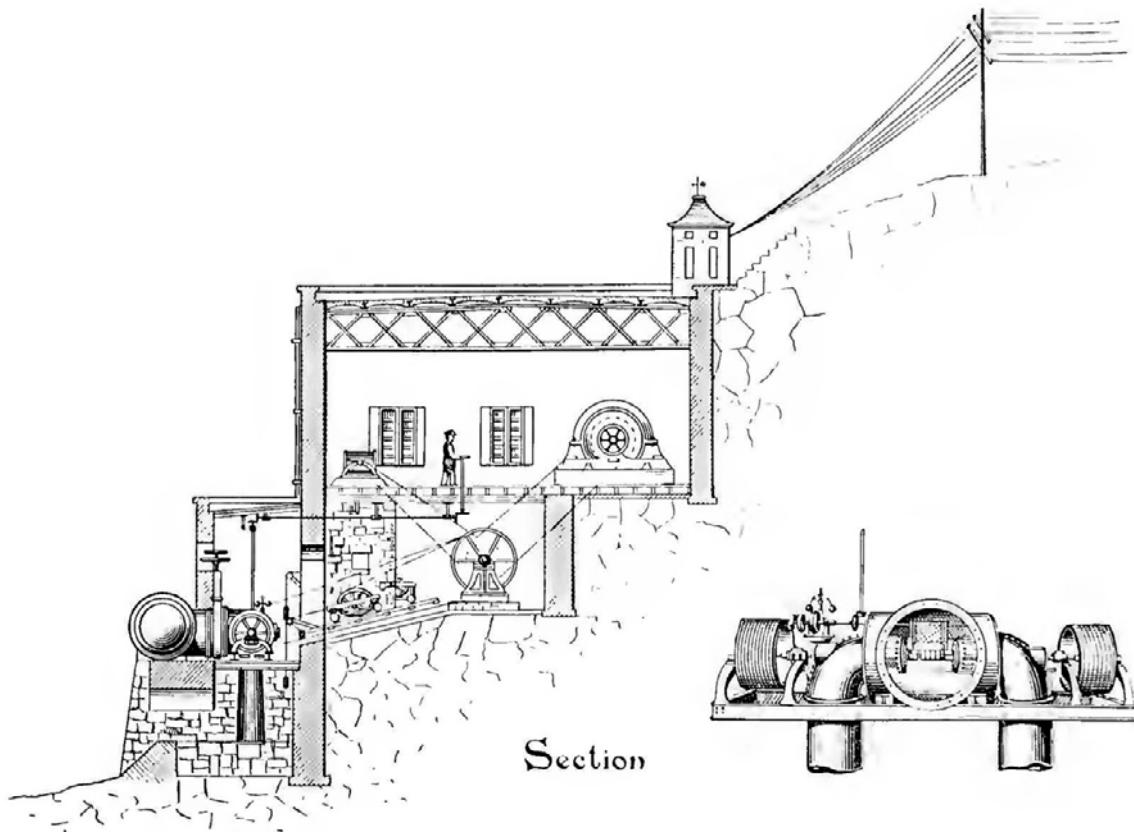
Sección transversal de la planta El Salto construida por Arozarena en 1893.
